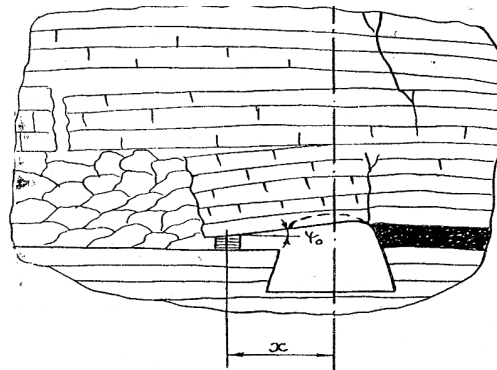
Схема обрушения пород кровли над сопряжением штрек-лава: ψ_0 – угол наклона кровли над выемочным штреком; x – длина активной части консоли пород кровли
